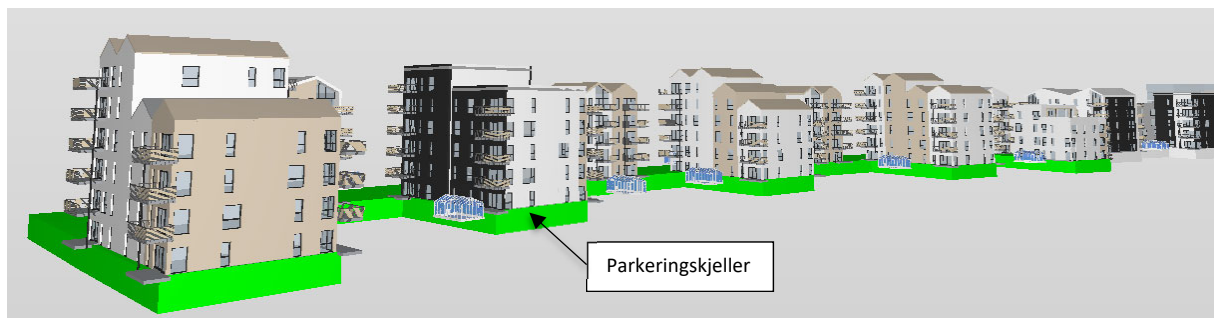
Planlagt utbygging på Hommelvik Stasjonsby sett fra nord-øst [kilde: www.hommelvikstasjonsby.no]
